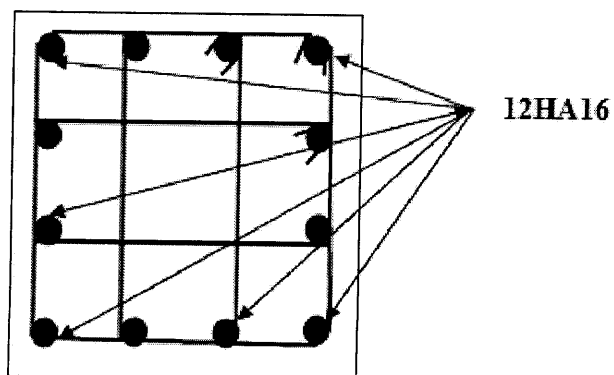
schéma de ferrailage des poteaux 55x50.
